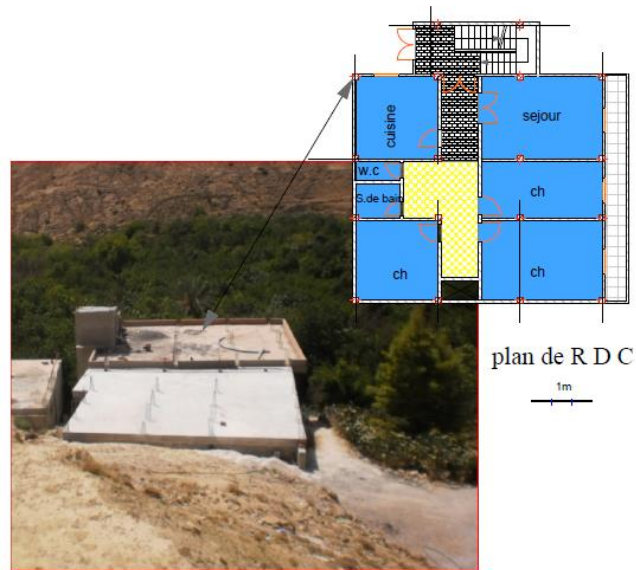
Vue extérieure et plan d'une construction au nouveau tissu de Menâa (Source : Auteur, 2018)
